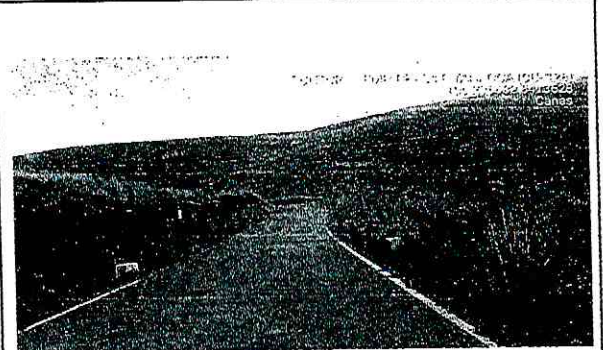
ALCANTARILLA DE CONCRETO, VIA EN BUEN ESTADO 105+500
